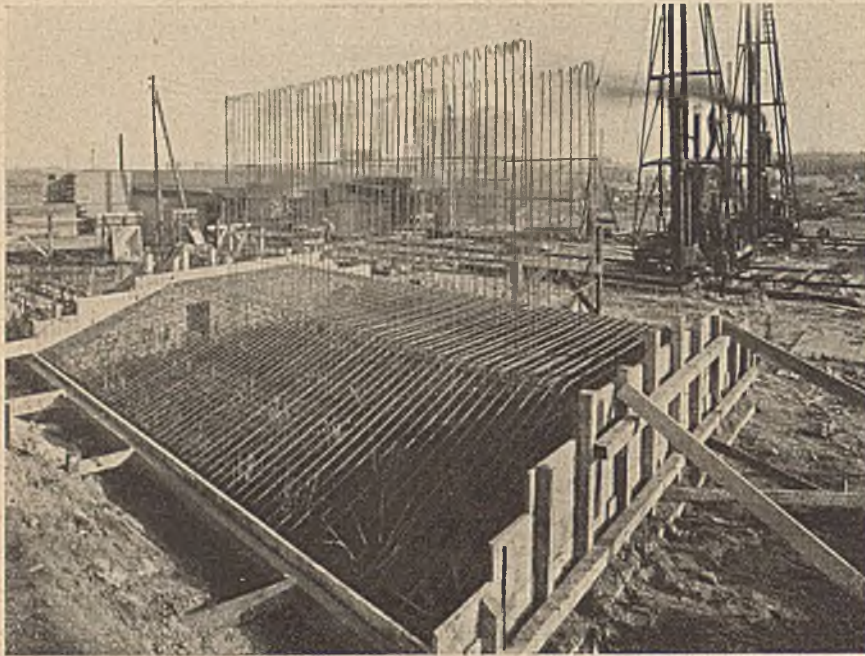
Bahnhof „Wernerwerk“. Bewehrung der Kopfplatte des auf Mast-Pfählen aufsitzenden Fundamentes und Bewehrung für den aufgehenden Beton des Pfeilers südlich am Siemensdamm.
